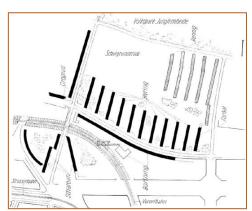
Plan de masse de La cité SIEMENSSTADT
